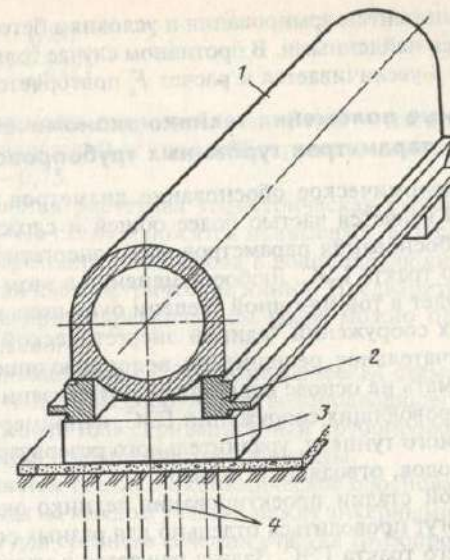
Сталежелезобетонный трубопровод на свайных опорах:
